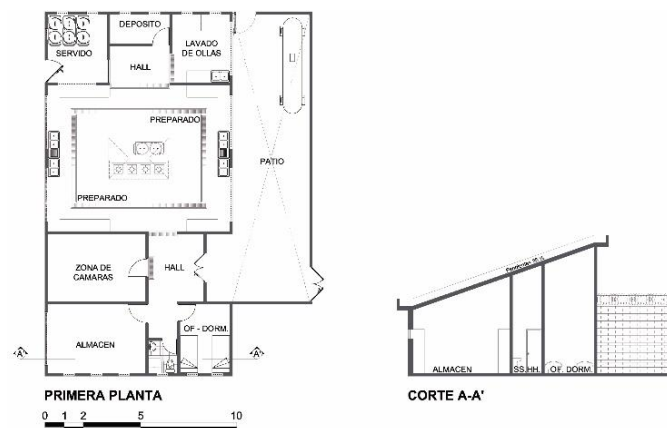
Planta y corte del patio de maniobras de la zona A
